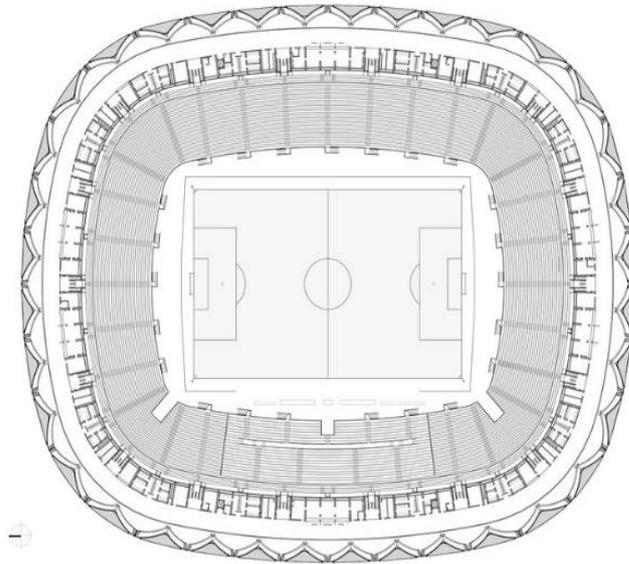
Planta Baixa 1º Pavimento – Arena da Amazônia
